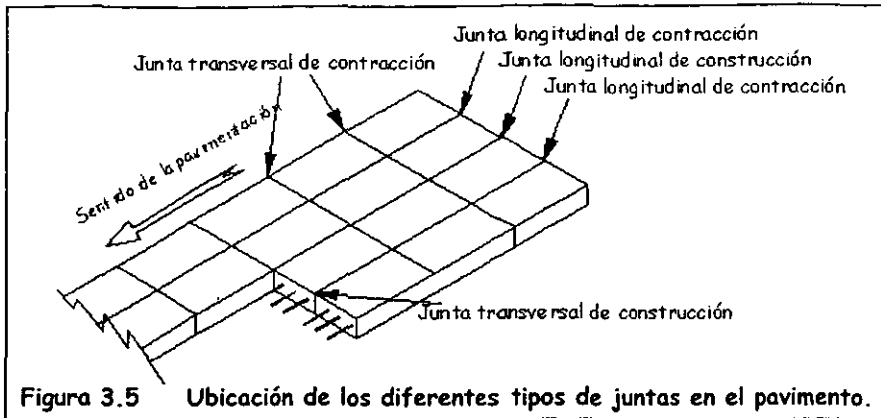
Ubicación de los diferentes tipos de juntas en el pavimento.
